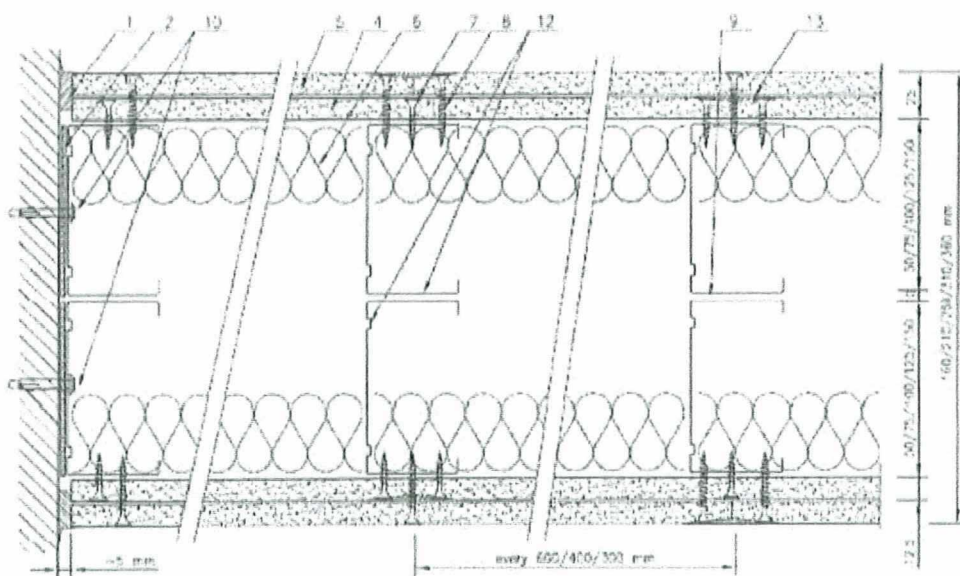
Vertikal- und Horizontalschnitt von einbruchshemmenden nichttragenden zweilagigen Trennwänden mit doppeltem Ständerwerk (mit getrennten Ständern)
